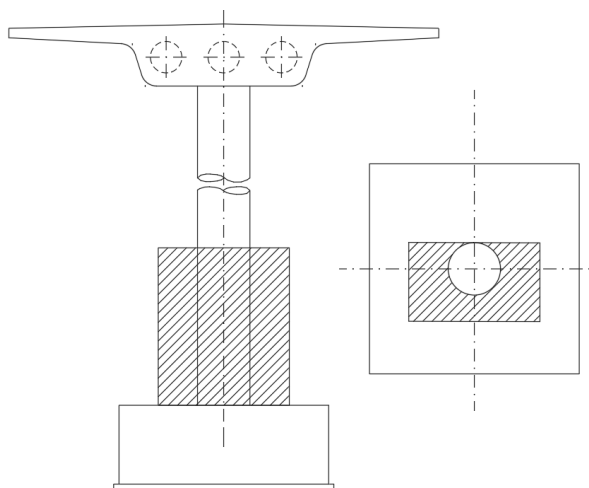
Esquema de alzado y planta del refuerzo de la pila.
